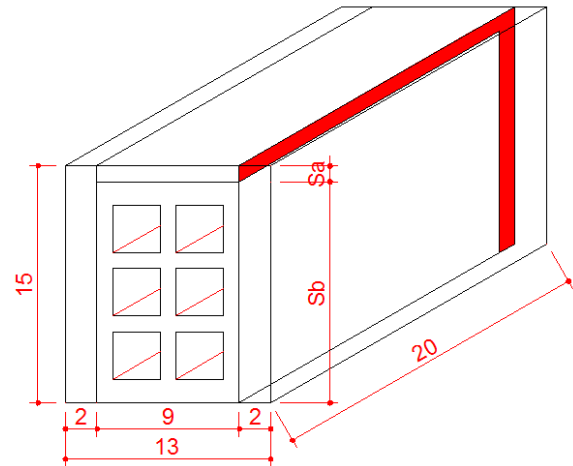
Tijolo de barro de seis furos com aplicação de argamassa de assentamento e reboco dos dois lados (interno e externo), indicação das seções S_a e S_b
